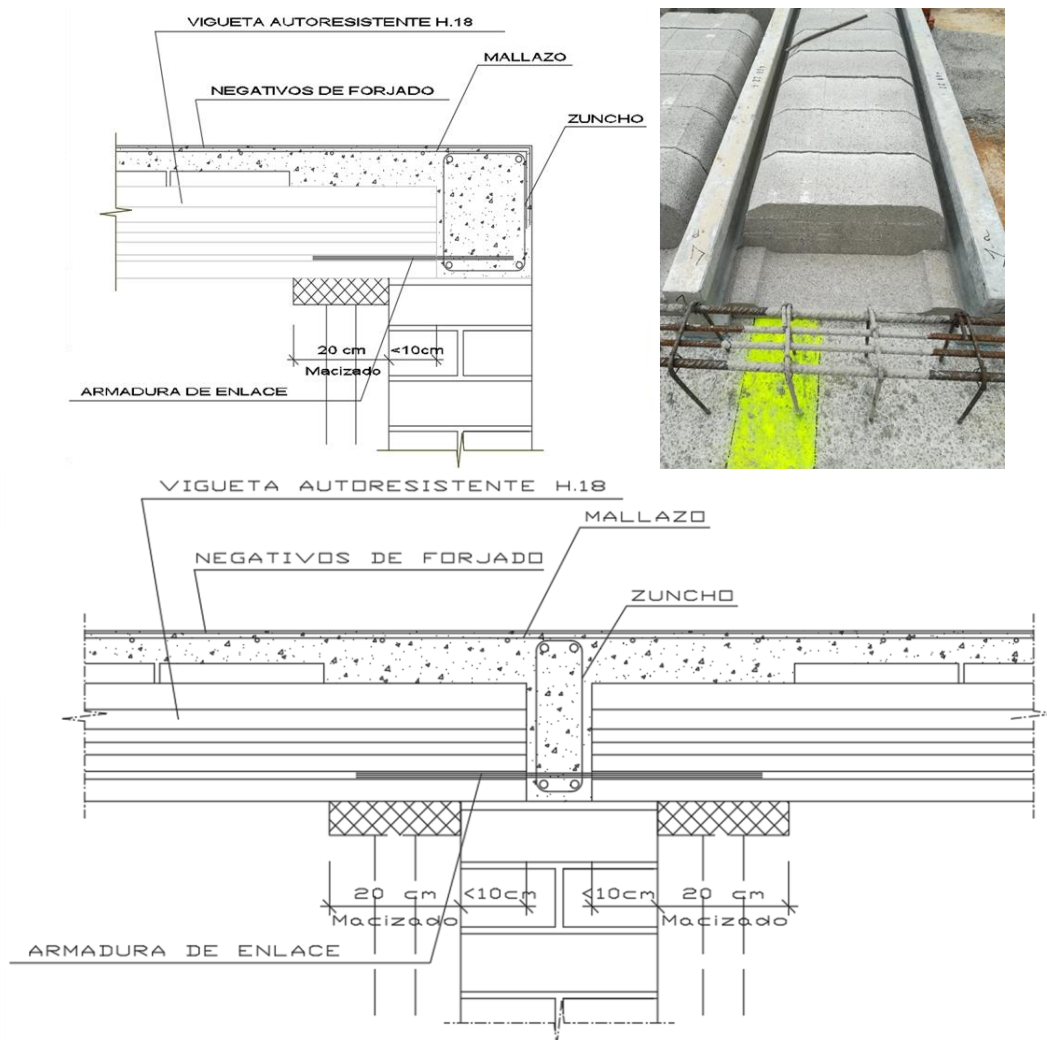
Rigidització del recolzament de les biguetes. *Prefabricats Pujol*.
